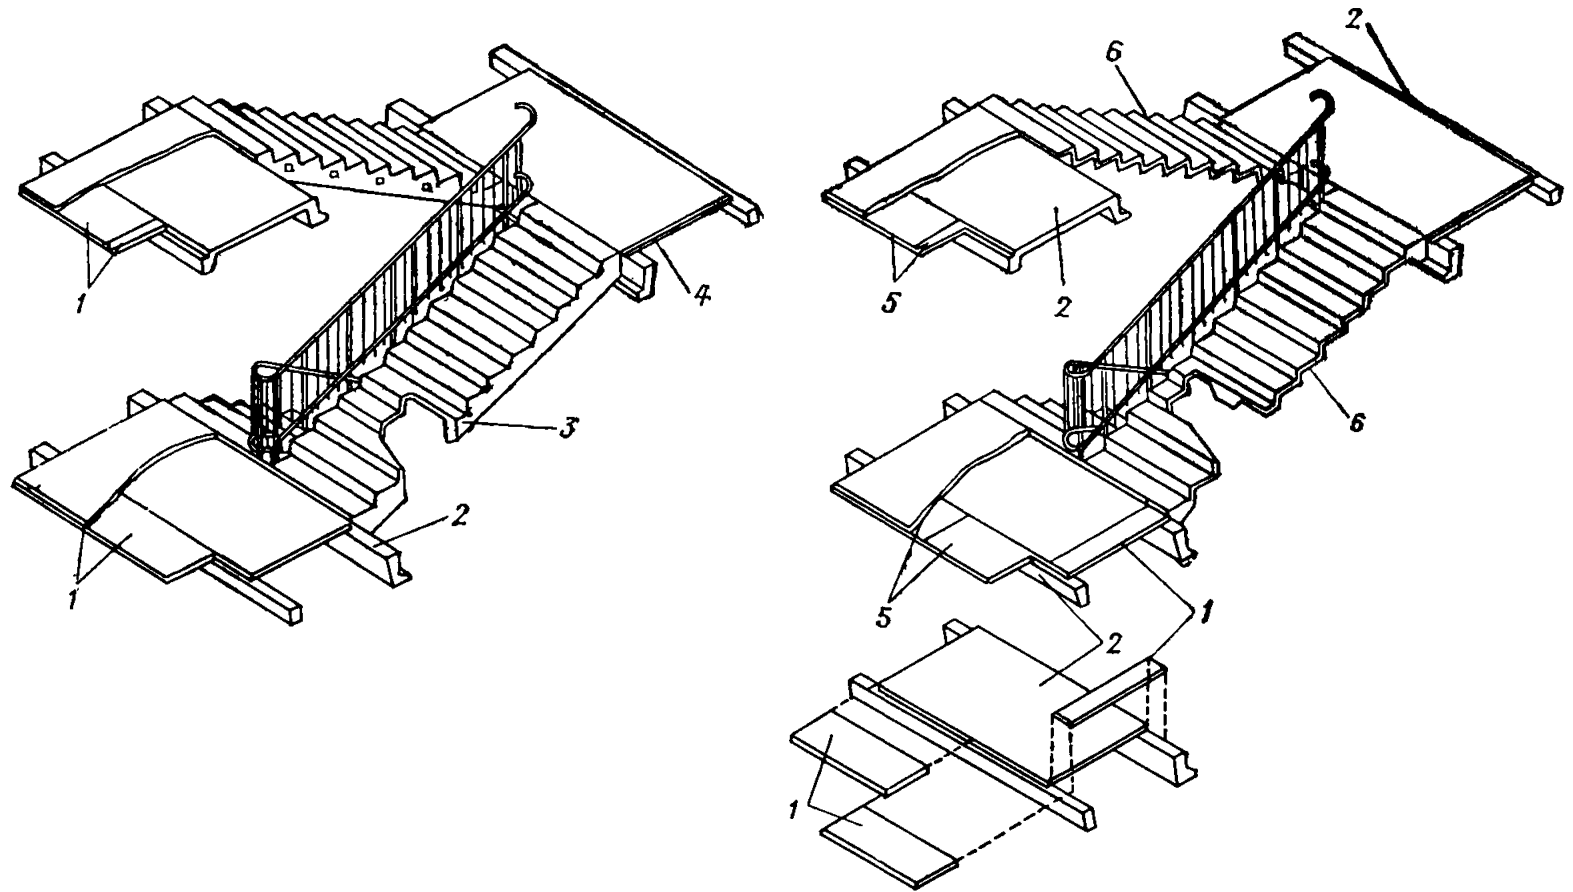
Сборные железобетонные лестничные марши и площадки
